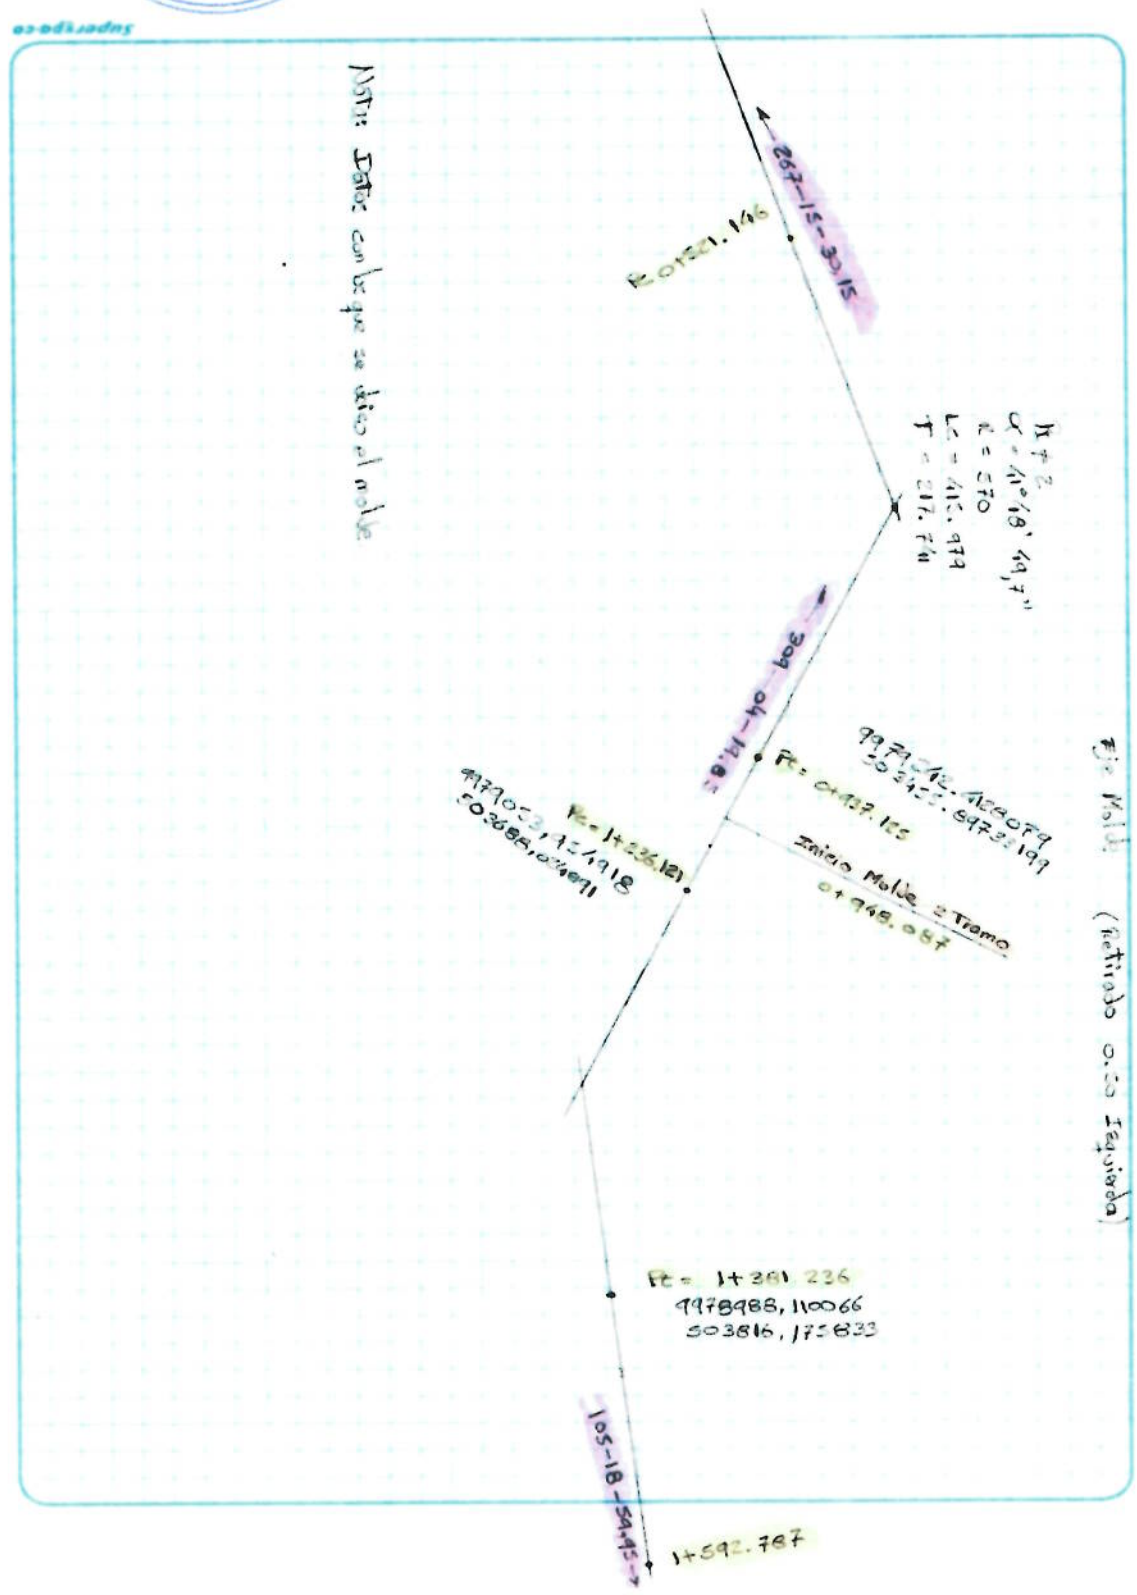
Geometría en Planta para la construcción del Túnel Guayasamin - Sur
